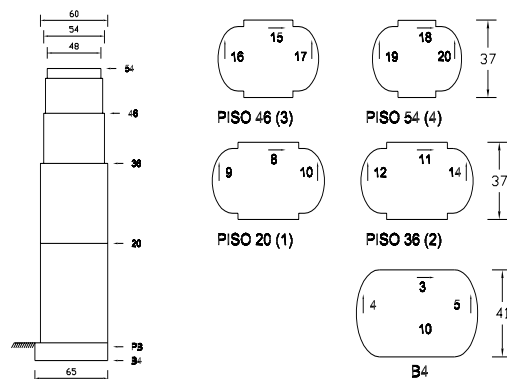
Vista en planta del edificio (dimensiones en m)
